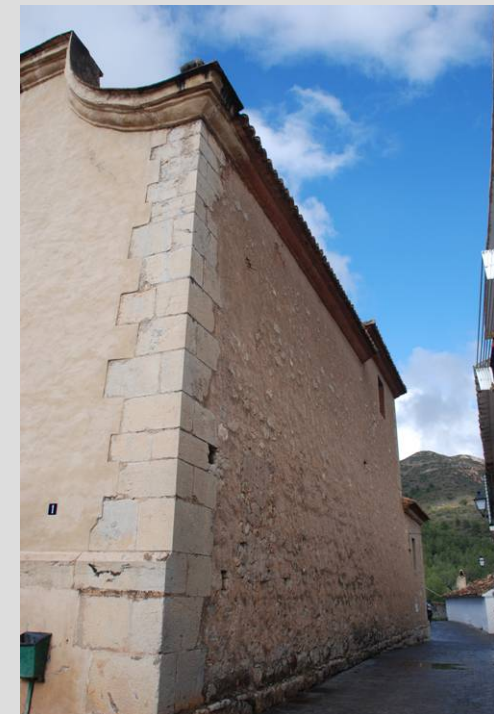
Muros de mampostería ordinaria con encadenado de sillares
